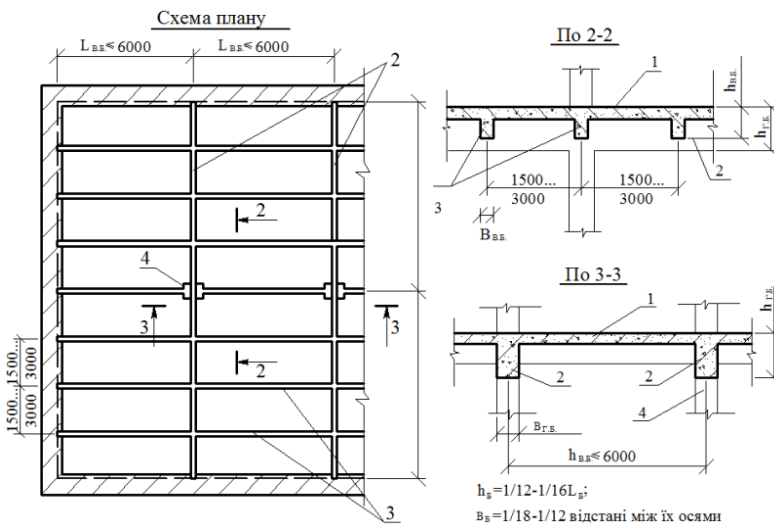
Монолітне залізобетонне перекриття у вигляді ребристого перекриття 1 – плита товщиною 60 – 100 мм; 2 – головні балки; 3 – другорядні балки; 4 – колона
